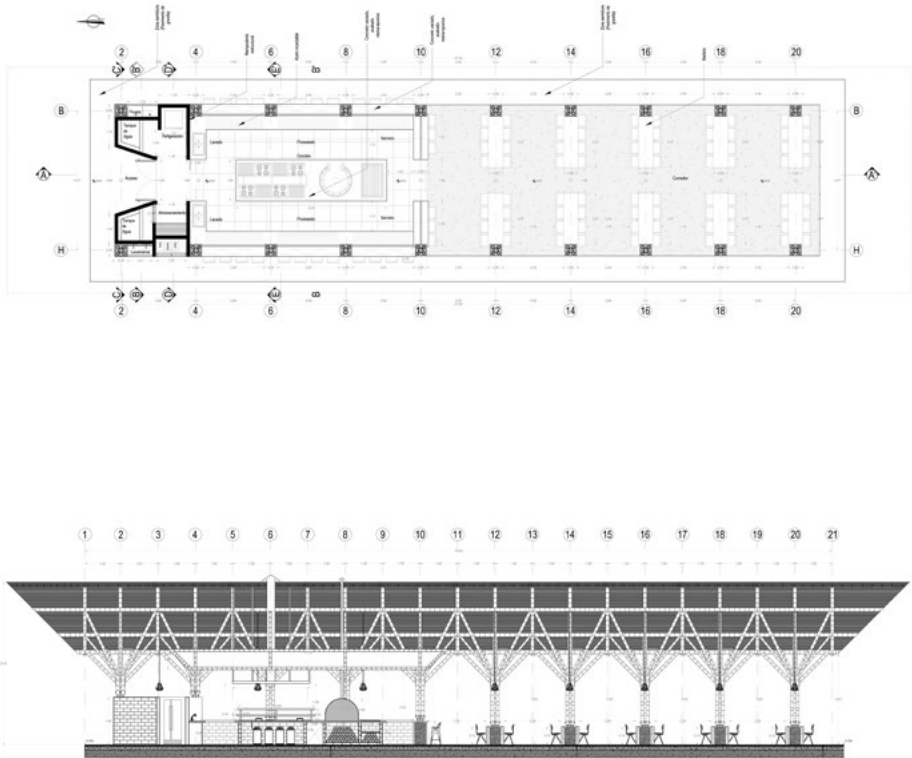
Plano con planta y corte arquitectónico de la cocina-comedor Santo Domingo.
